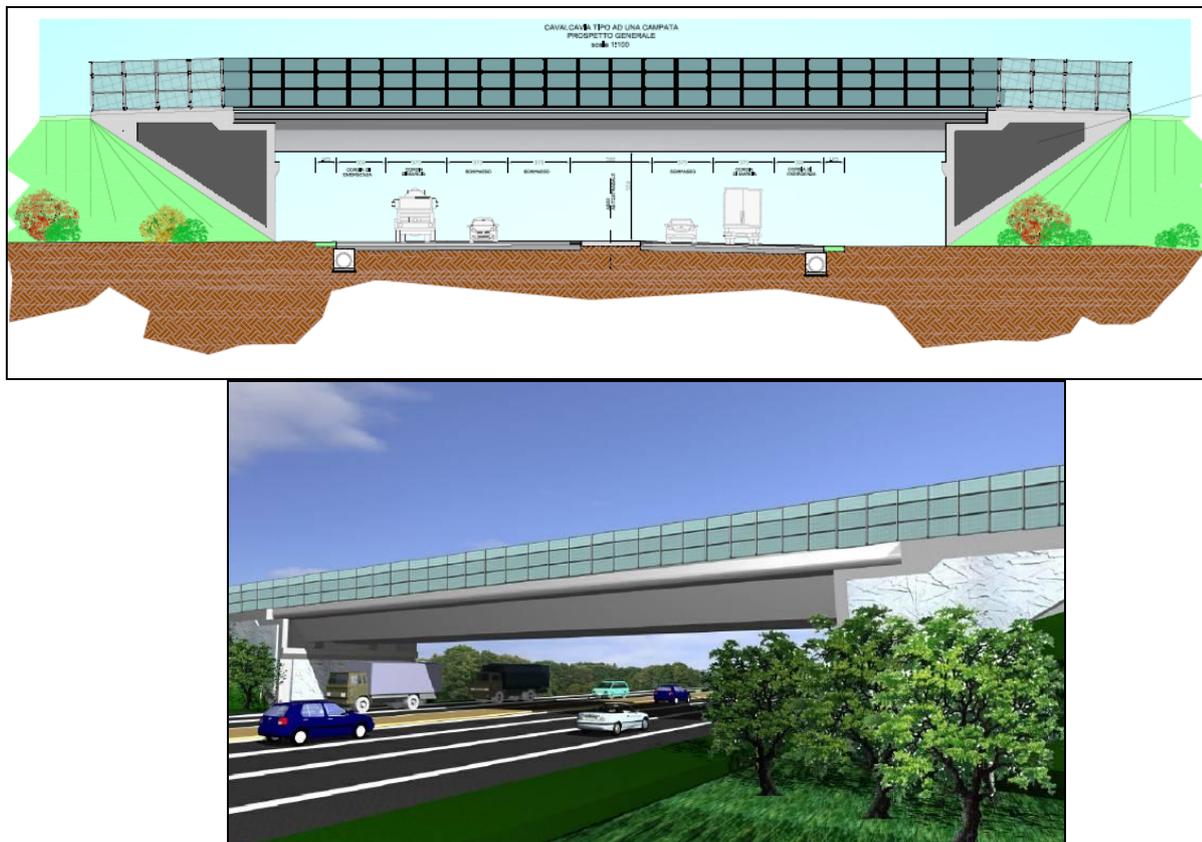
/7 Prospetto tipologico e vista prospettica dei cavalcavia in progetto
